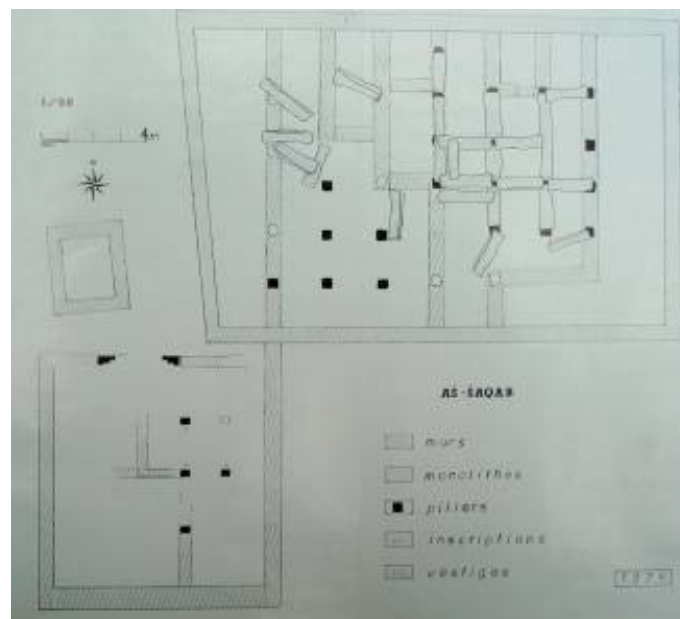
Rilievo planimetrico del complesso nel 1978 (Robin-Breton-Audouin 1979, 426)
